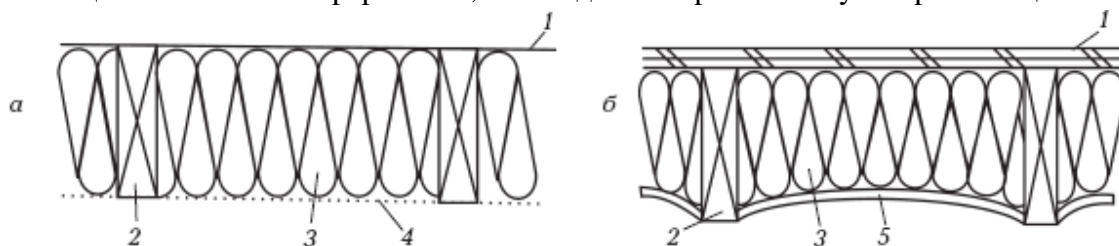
Крепление теплоизоляции к каркасу пола: а) до монтажа перекрытий; б) снизу, после монтажа перекрытий; 1 – пол; 2 – лага; 3 – утеплитель; 4 – сетка; 5 – пружинная проволока
